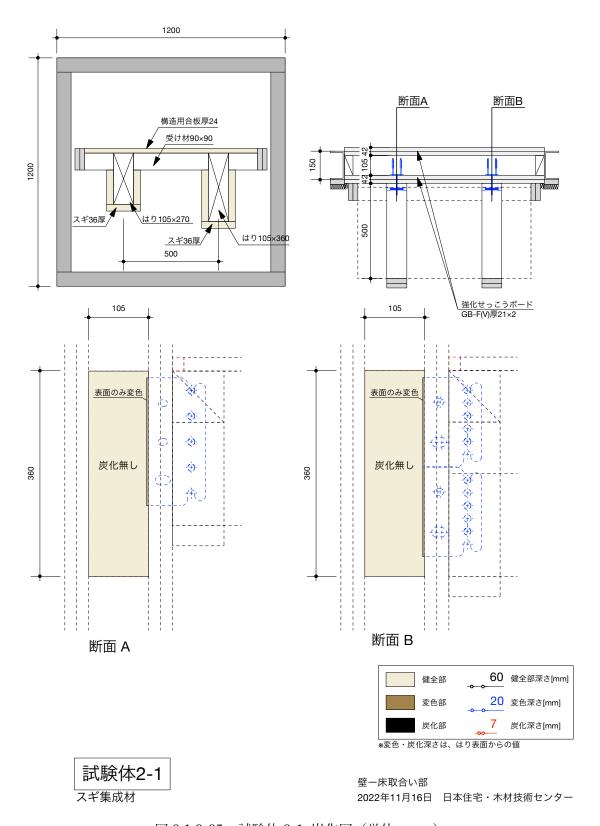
試験体 2-1 炭化図(単位:mm) ※梁受け金物を取り付けるために元々4mm 深さで座掘りされている
